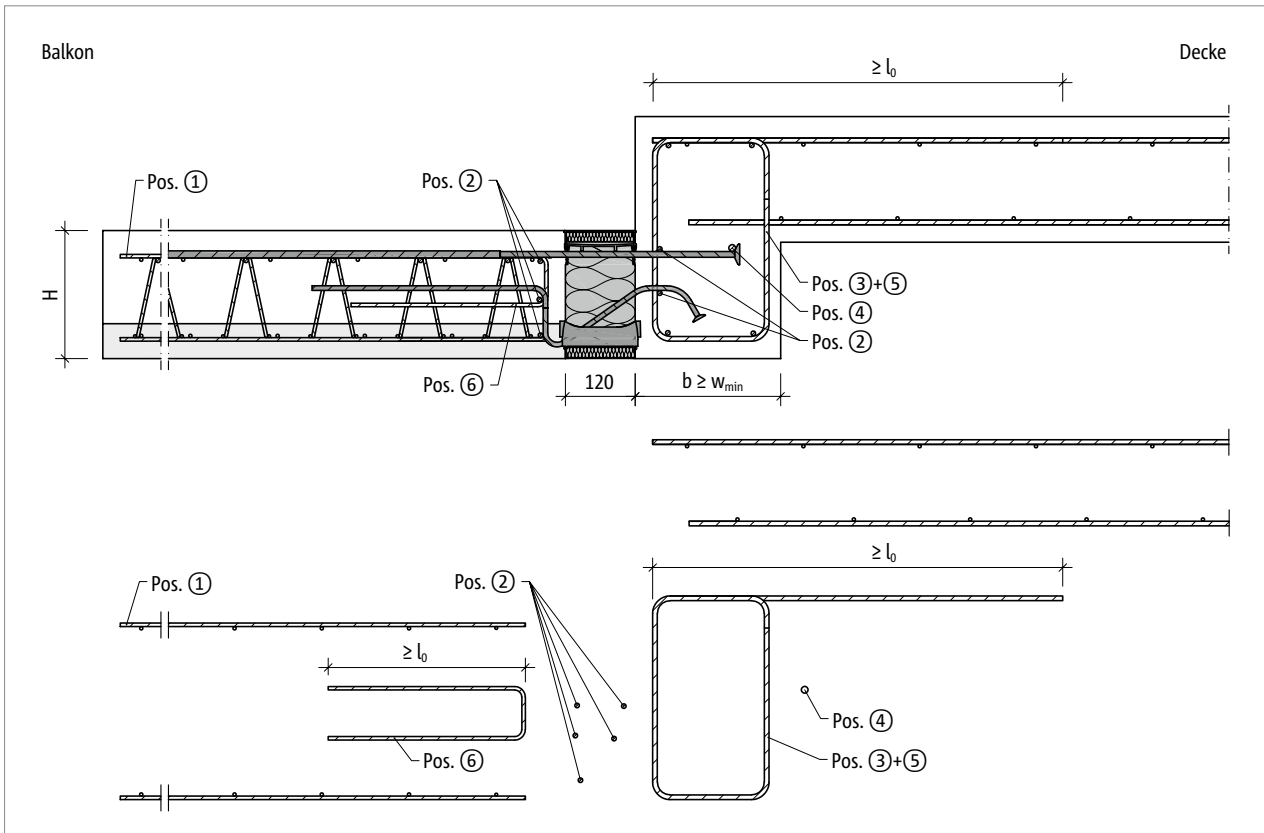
Schöck Isokorb® XT Typ KL-U-F: Bauseitige Bewehrung für Balkon mit Höhenversatz nach unten
